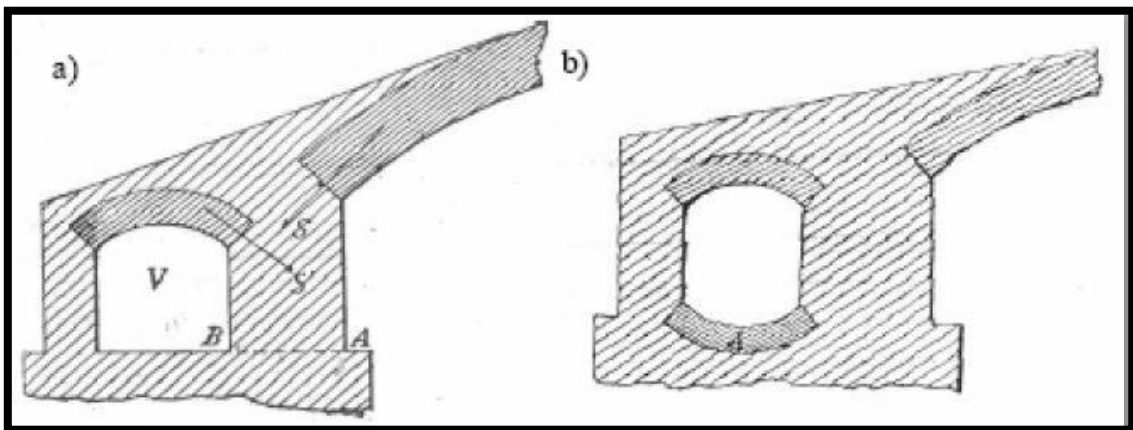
Spalle con vani interni. (Fonte: BAGGI, G., 1926.)
